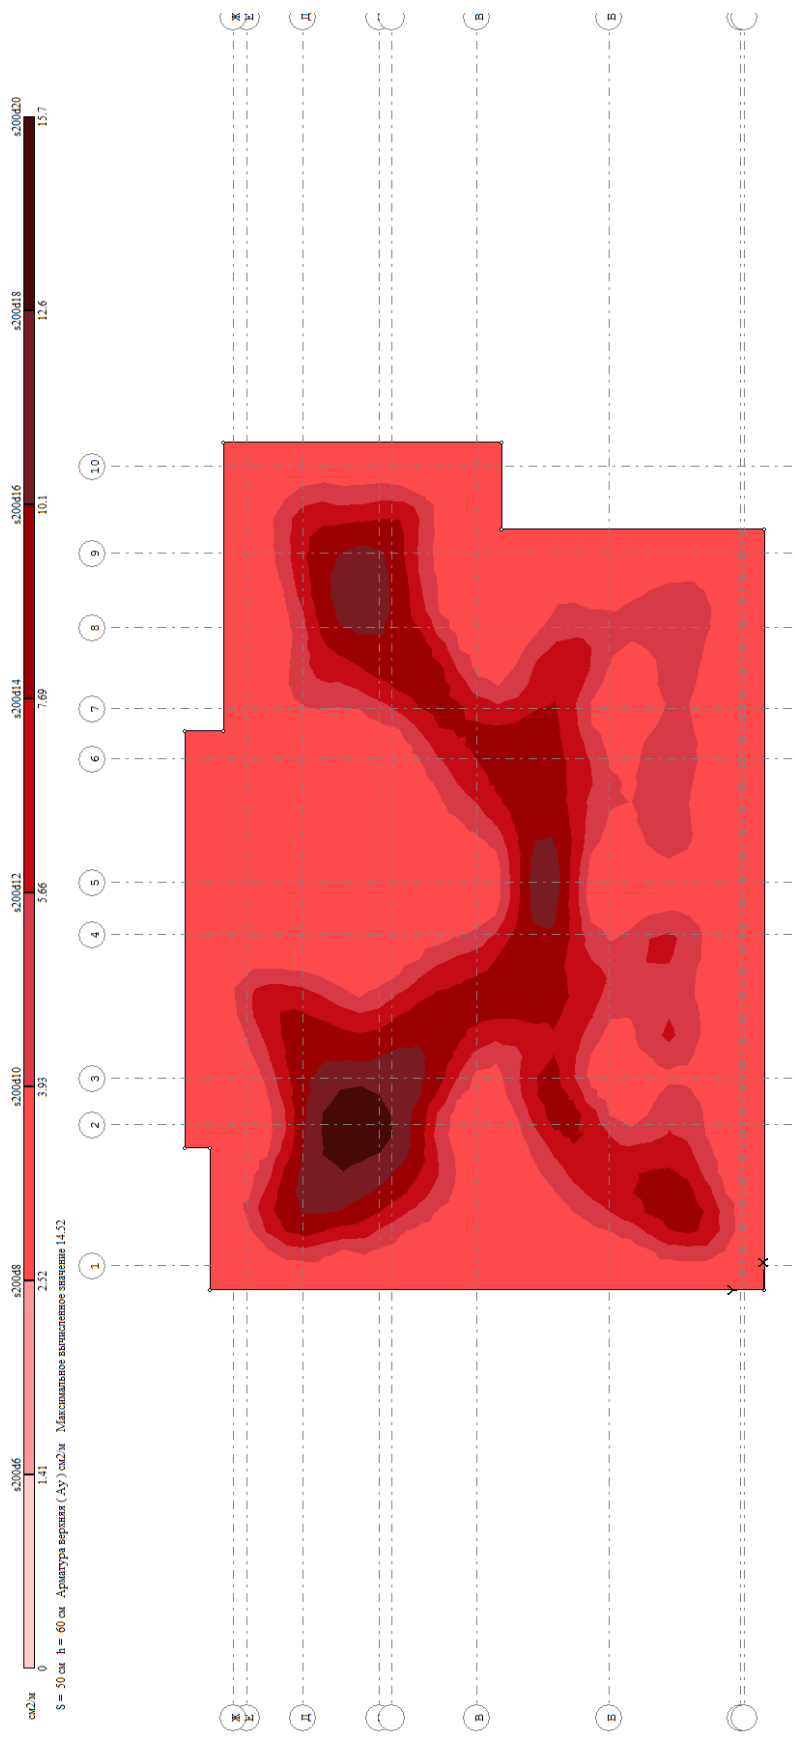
Верхняя арматура по Y - фундаментна плита
